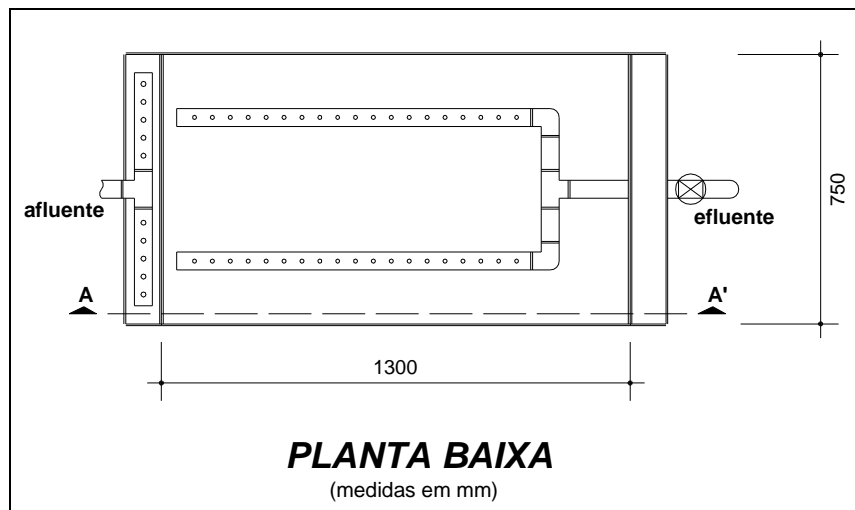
Planta baixa do pré-filtro dinâmico.
